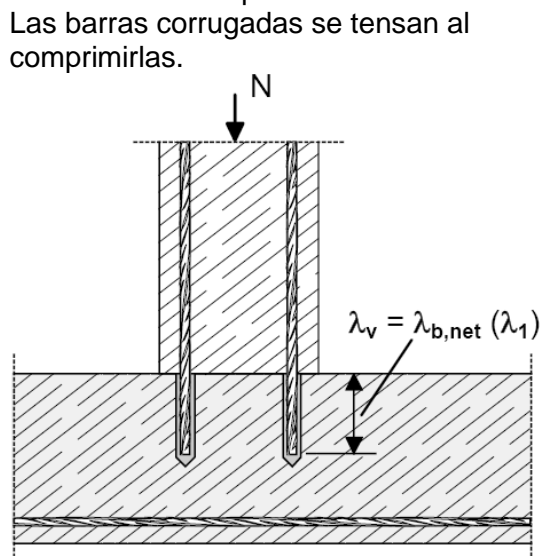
Junta superpuesta en la base de una columna o pared donde las barras corrugadas están sometidas a tensión
